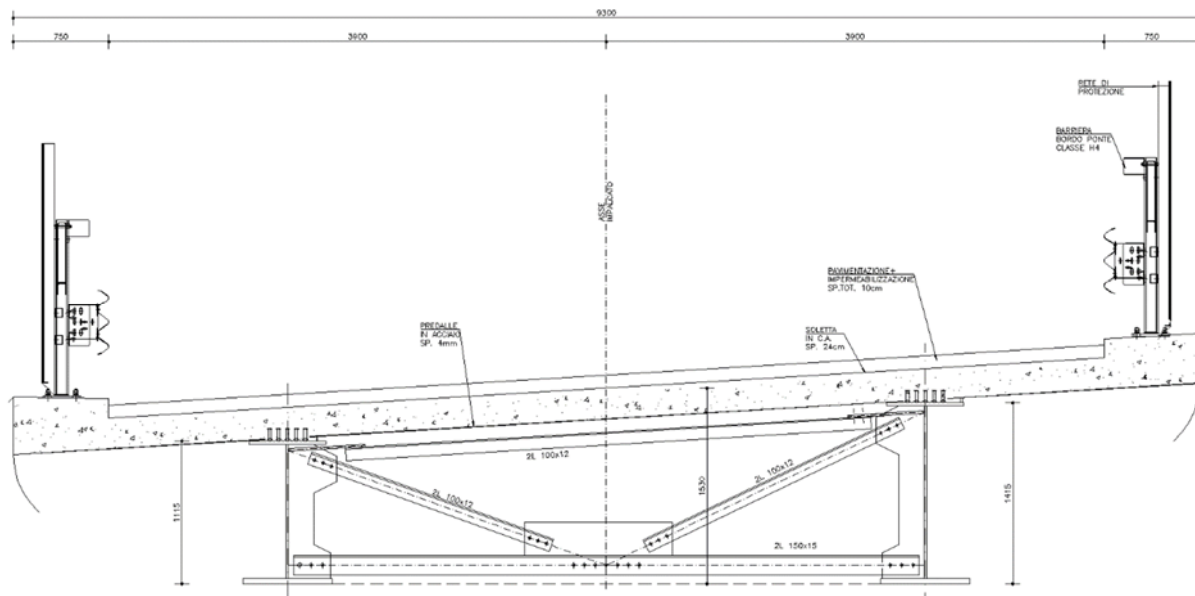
Sezione trasversale dell'impalcato nel tratto di larghezza 9.30 m
